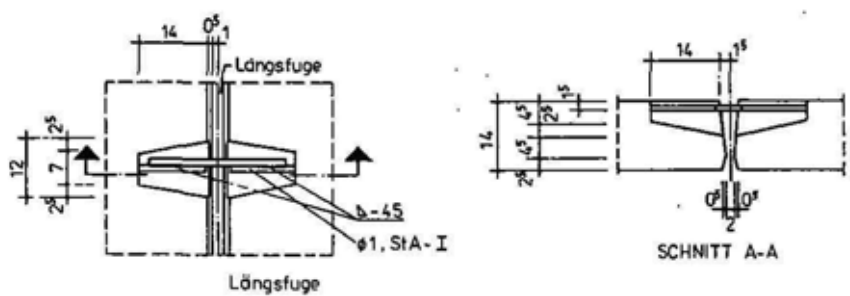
Verbindung von zwei Deckenelementen untereinander quer zur Spannrichtung
